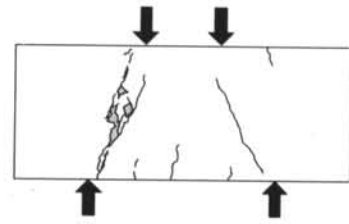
試験体 S10 のひび割れ発生状況 (実験)
